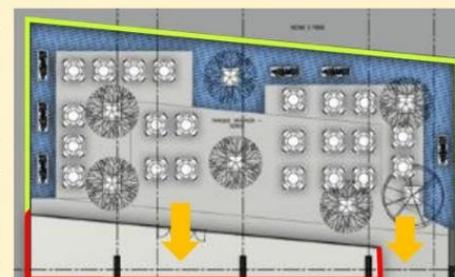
Planta del patio interior del edificio escala: 1/300 Fuente: www.archdaily.pe
